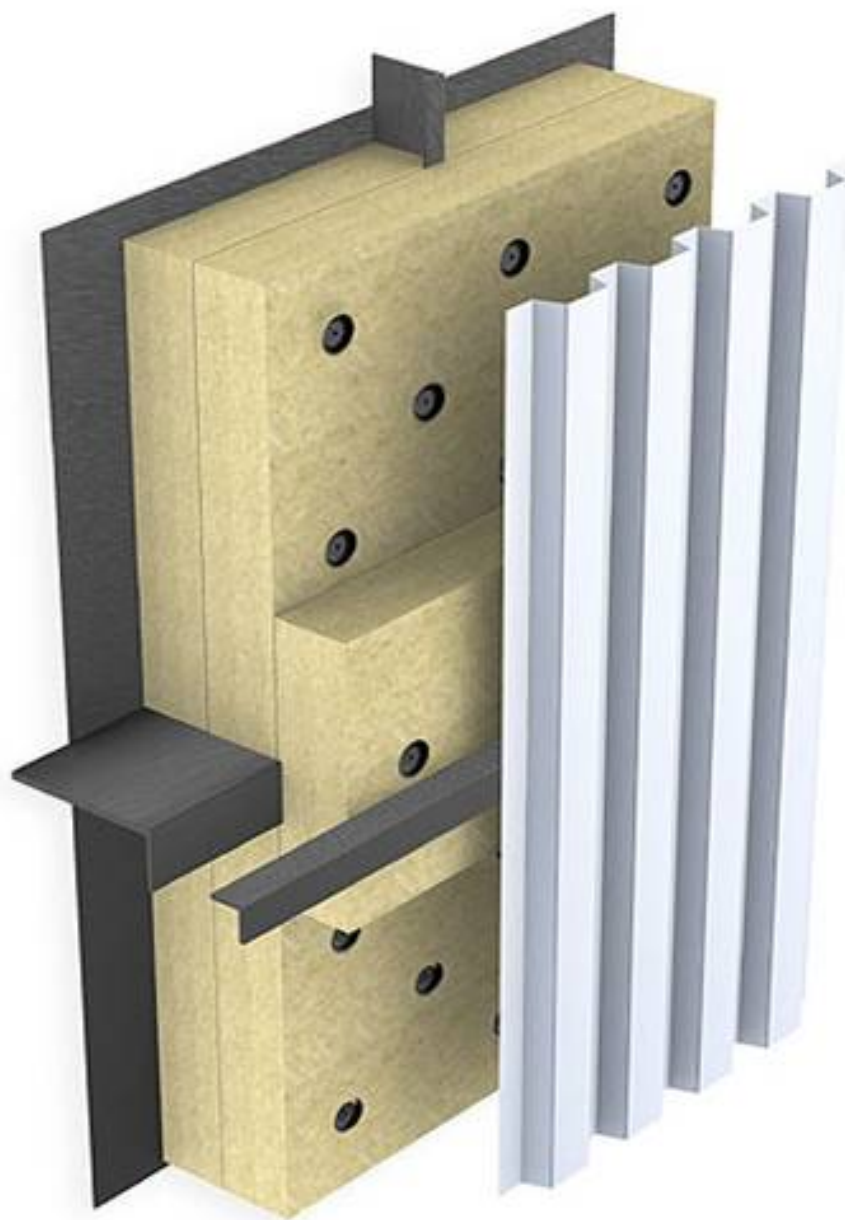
Теплоизоляция опорных элементов электрофильтров, воздухопроводов и газоходов
